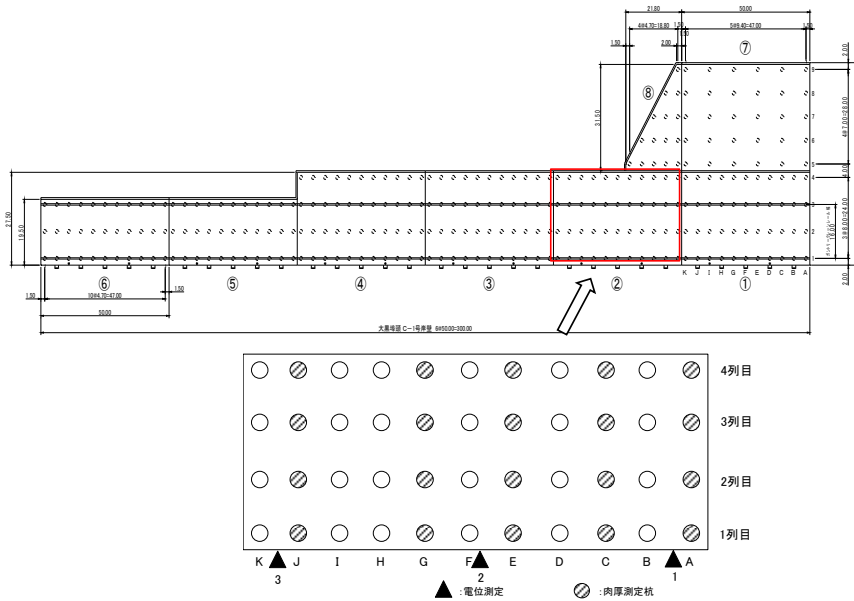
棧橋平面図と電位測定および肉厚測定箇所位置図
